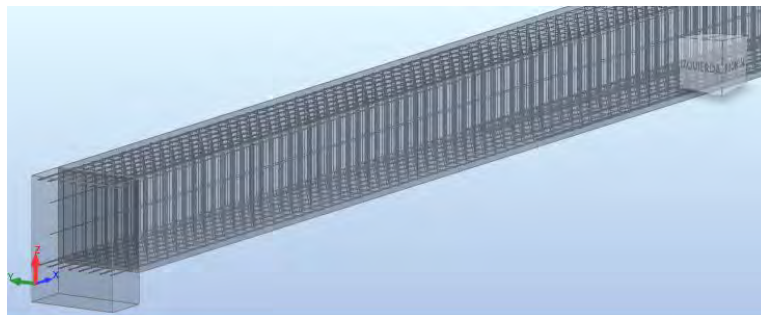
DETALLE DE CIMENTACIÓN
